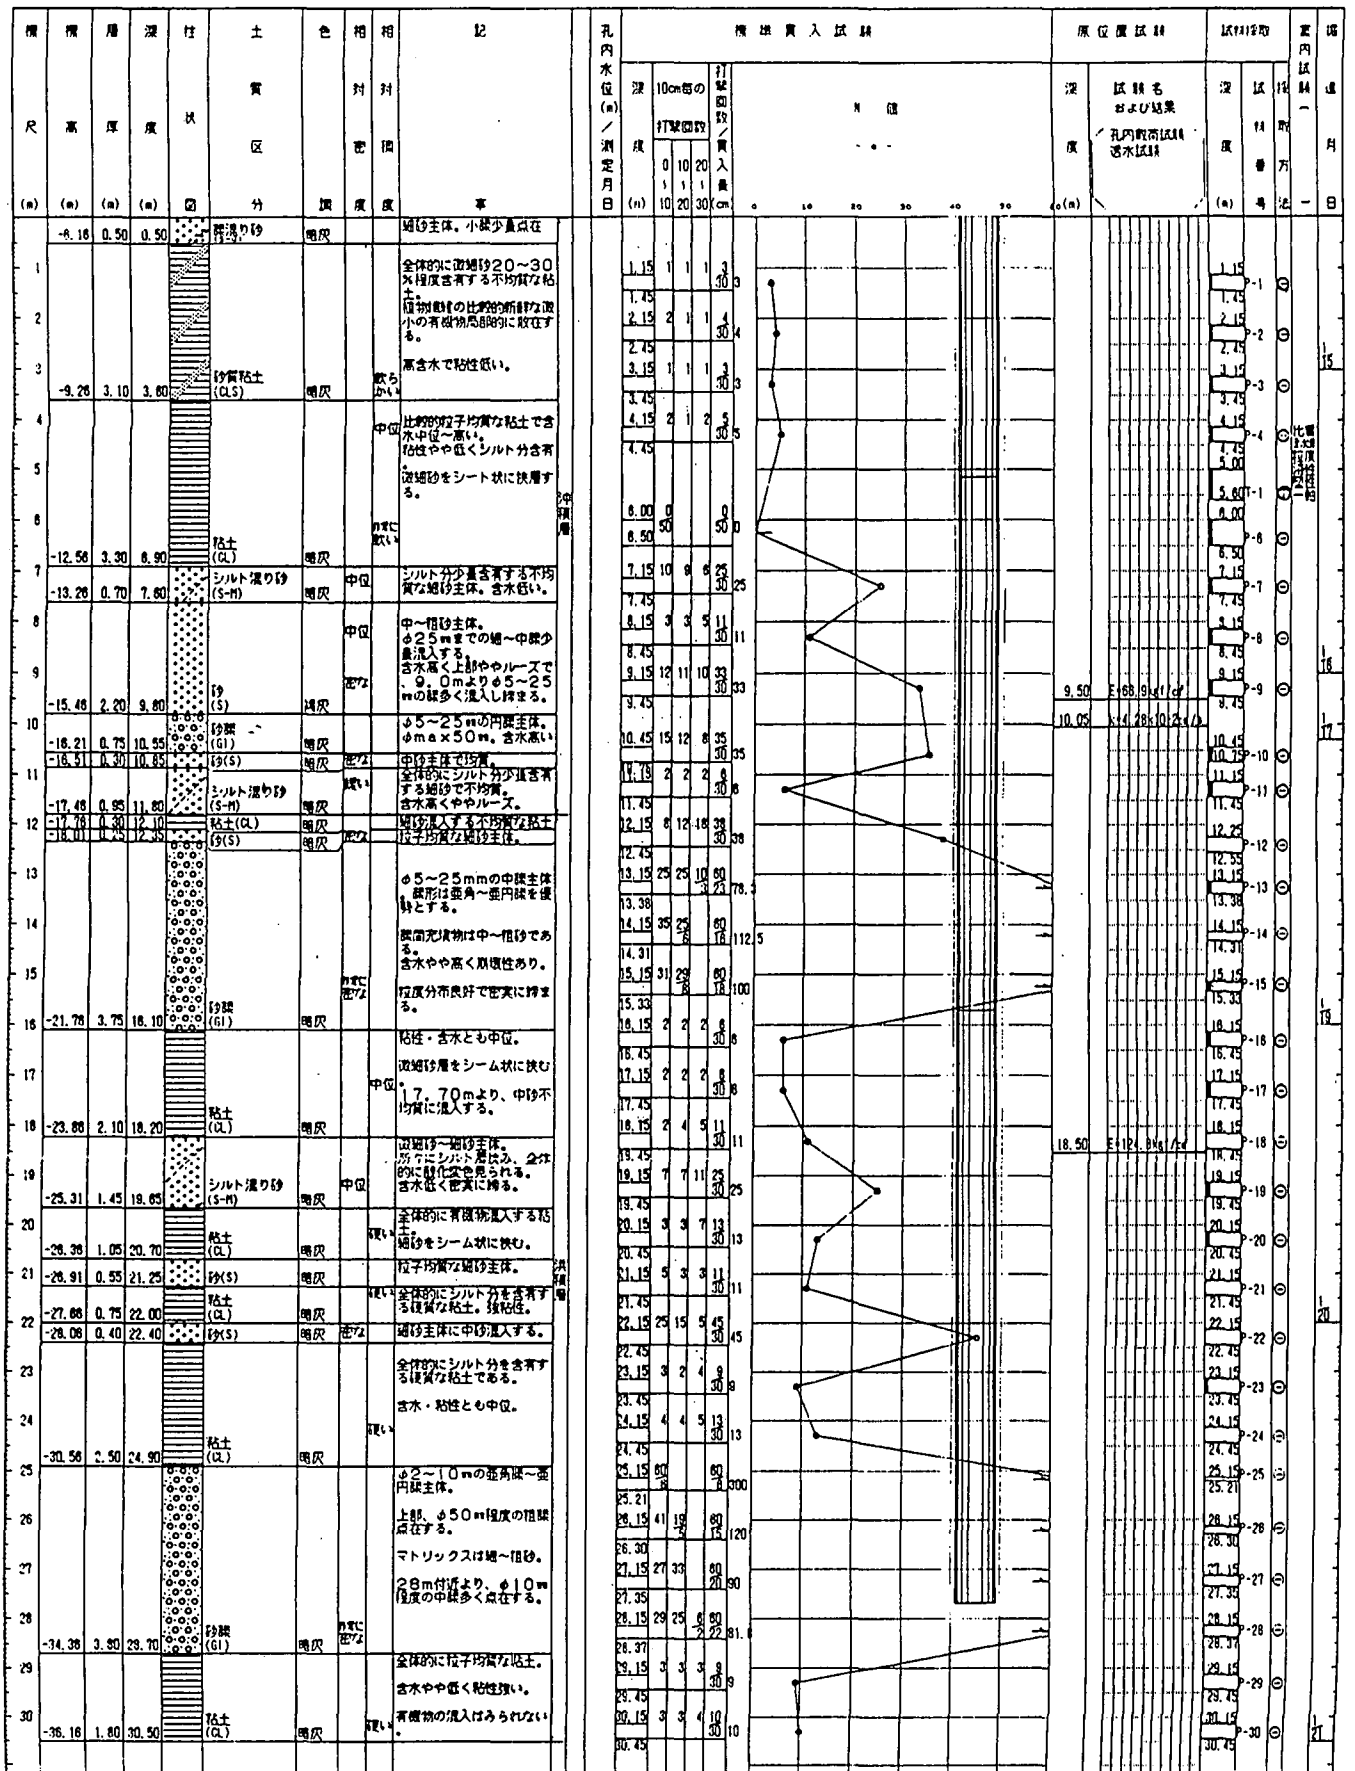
ボーリング柱状図 (P₁₁~P₁₂間)
